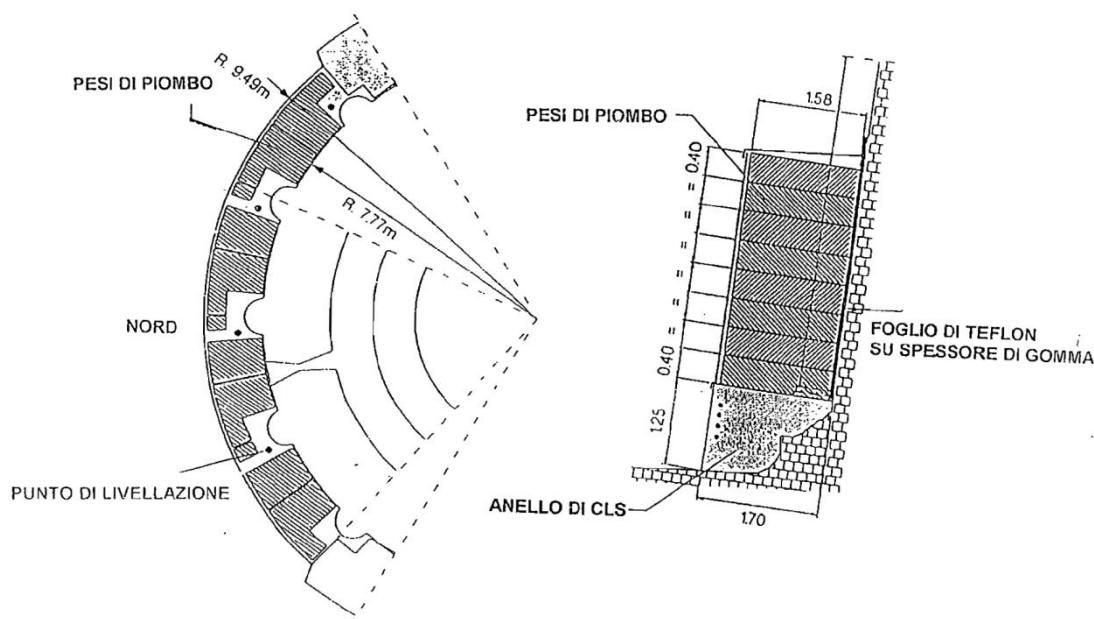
Schema dell'intervento di stabilizzazione provvisoria della Torre di Pisa: pianta dell'anello e posizionamento dei contrappesi di piombo (Desideri et al., 1997).
